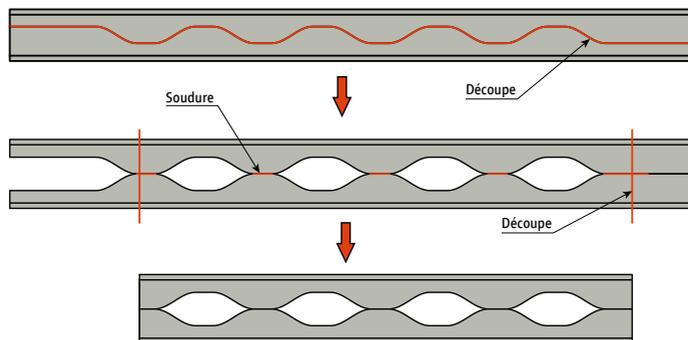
Poutre cellulaire à ouvertures sinusoïdales
